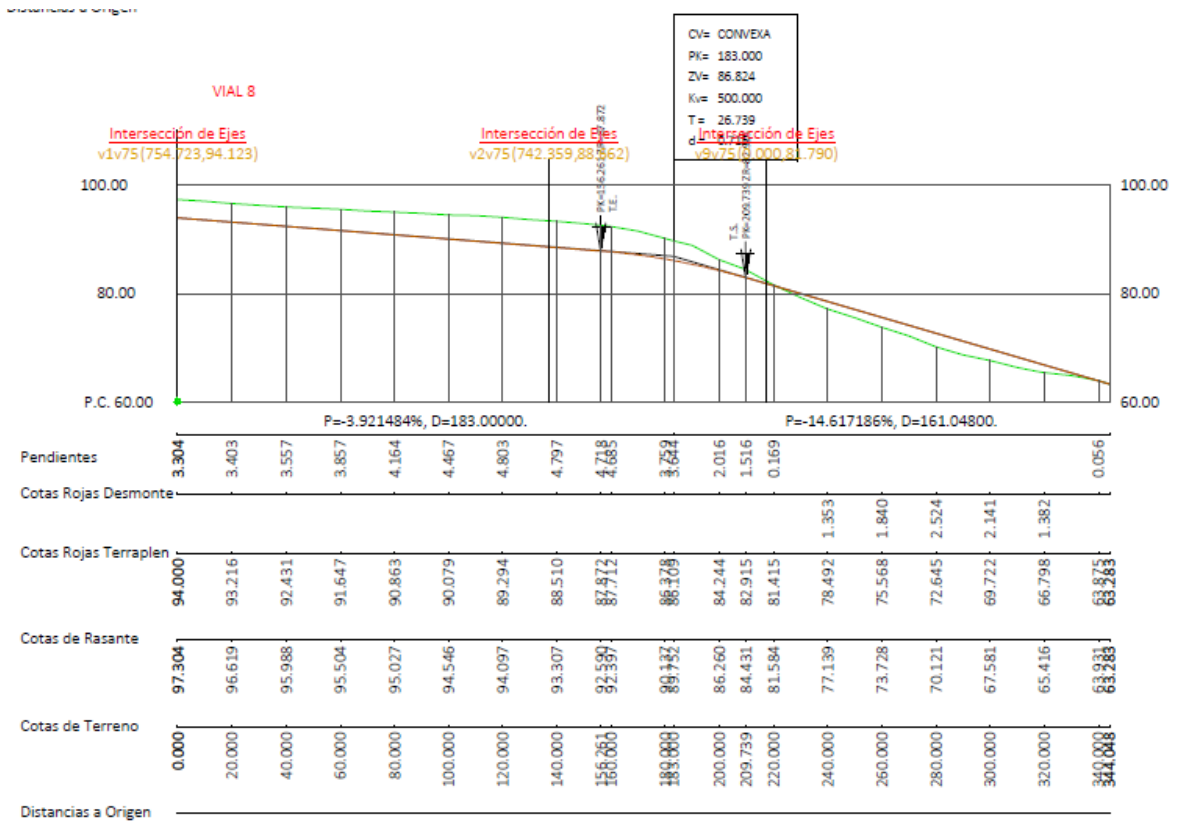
Imagen de la sección longitudinal del vial 8 en la alternativa 1.
